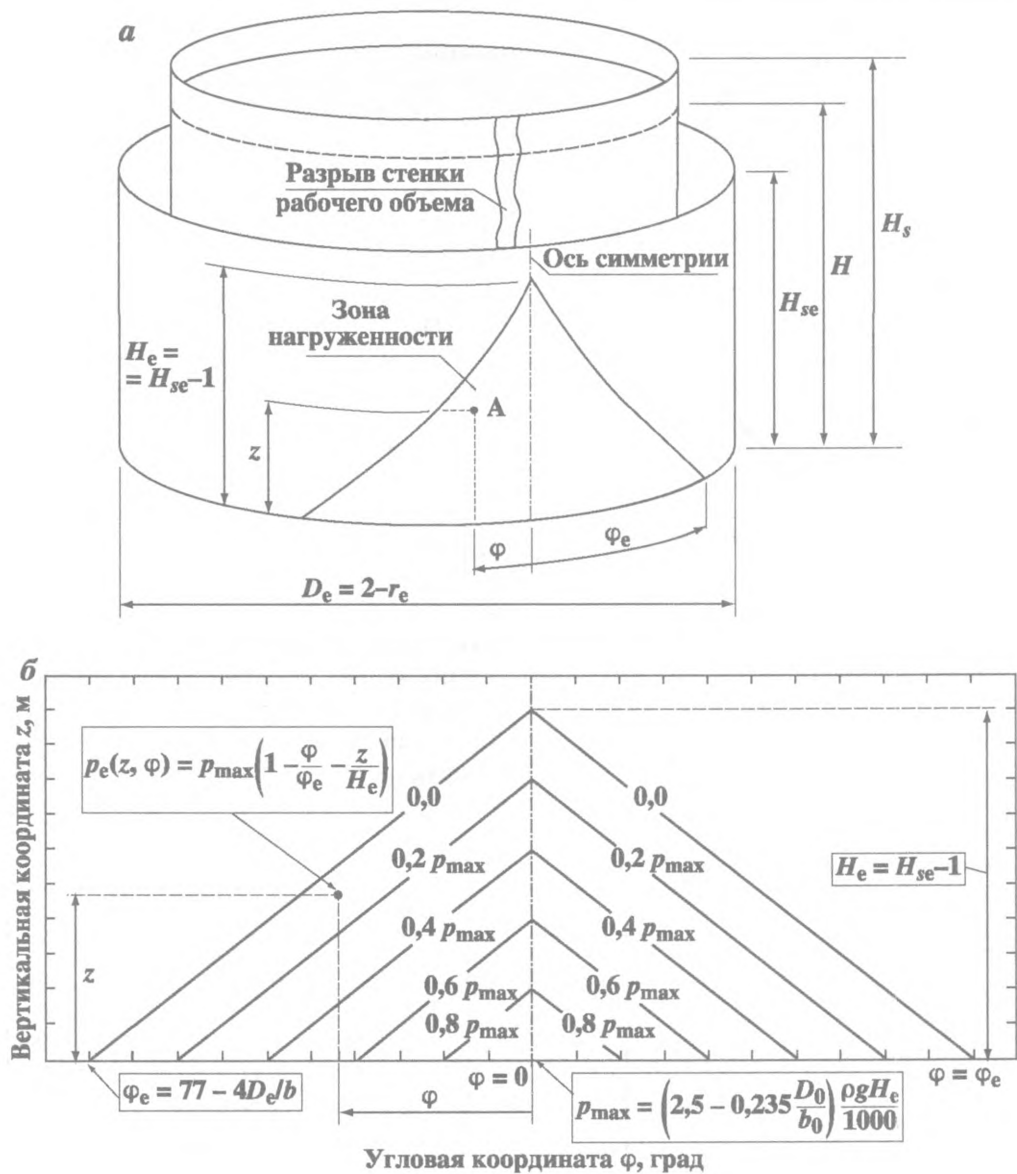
Схема приложения нагрузки для расчета защитной стенки:
